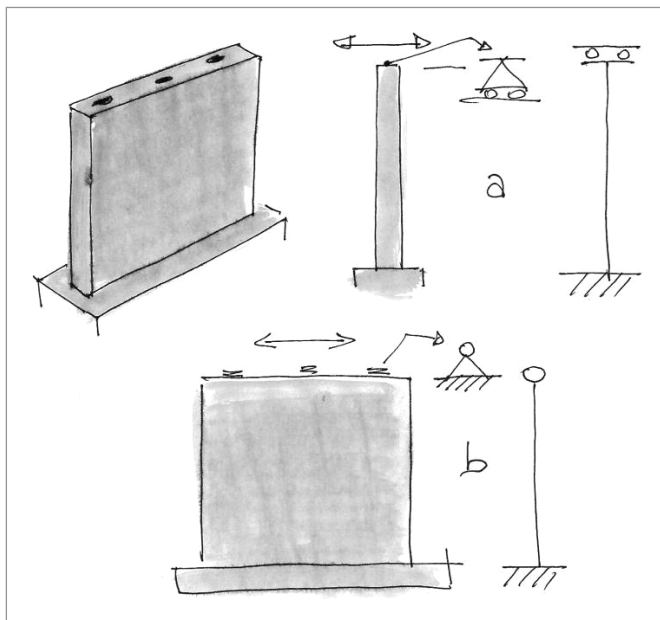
Possibile schema statico longitudinale (a) e trasversale (b)
